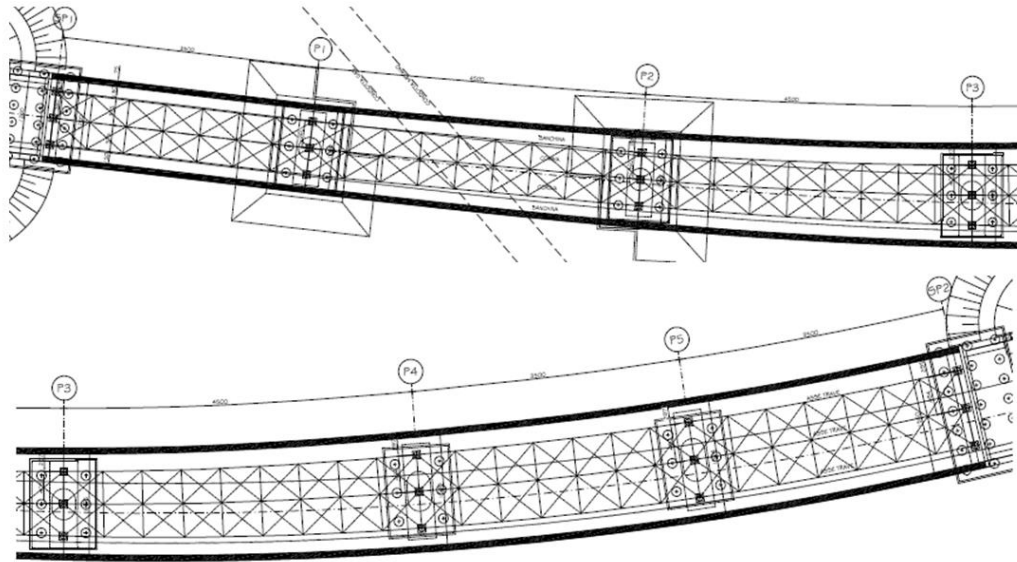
Viadotto dell'Acqua Calda: pianta impalcato
